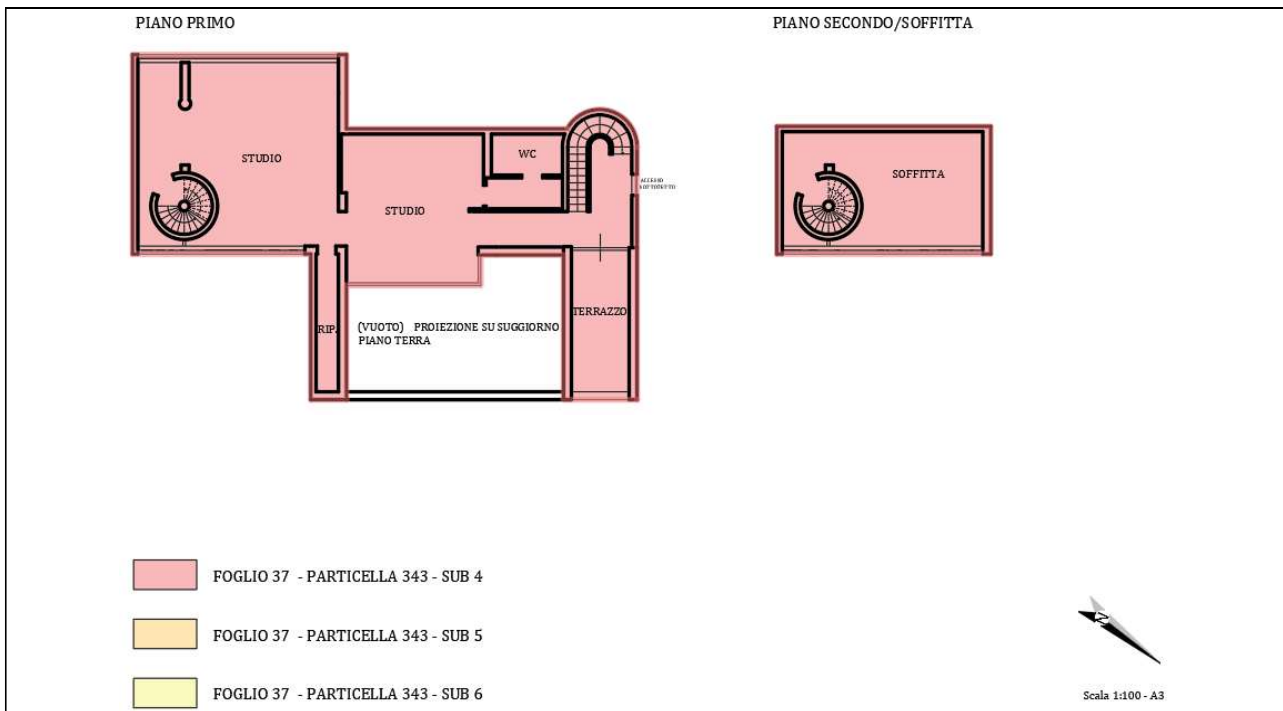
Planimetria dell'immobile – Piano Primo e piano secondo/soffitta
